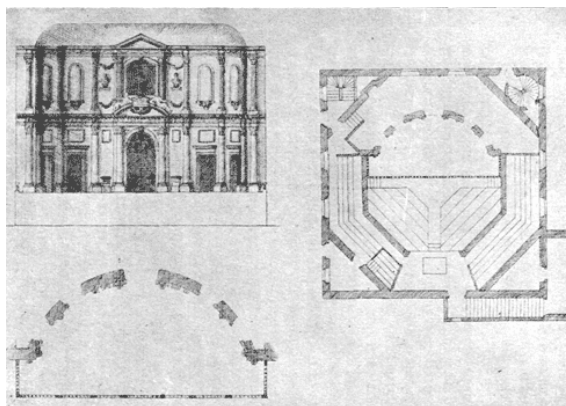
Alçado principal e planta de Inigo Jones do *Cockpit Real*, Londres
